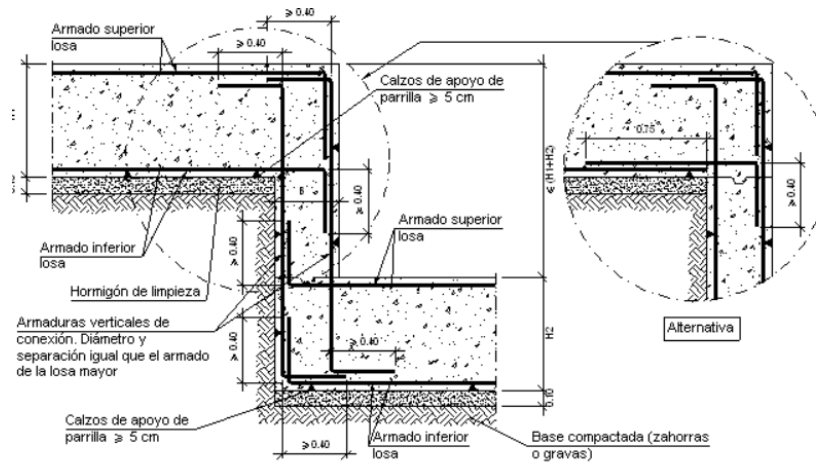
Detalle de muro de conexión entre losas de cimentación
